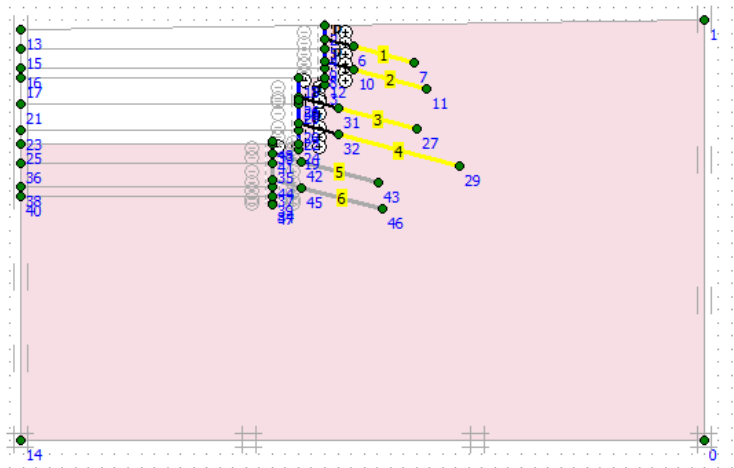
Geometría tras la ejecución de la 13ª Fase.
